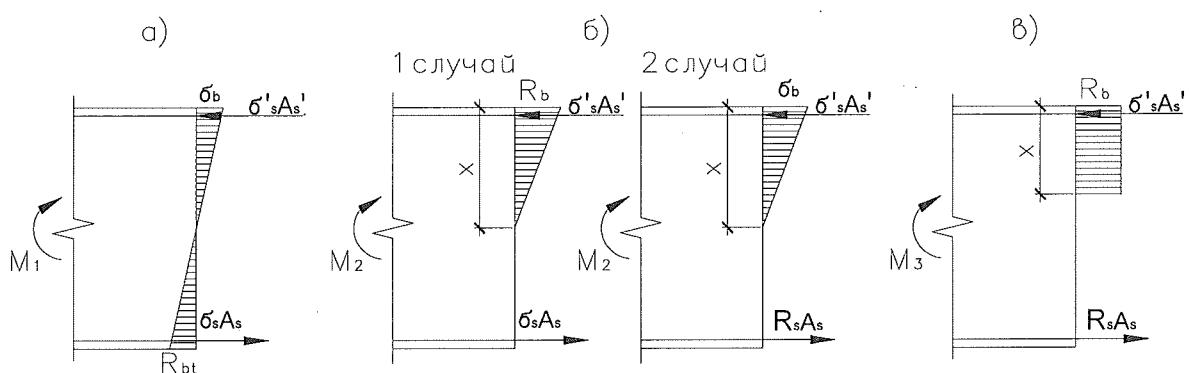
Схема напряженного состояния изгибающегося железобетонного элемента:
